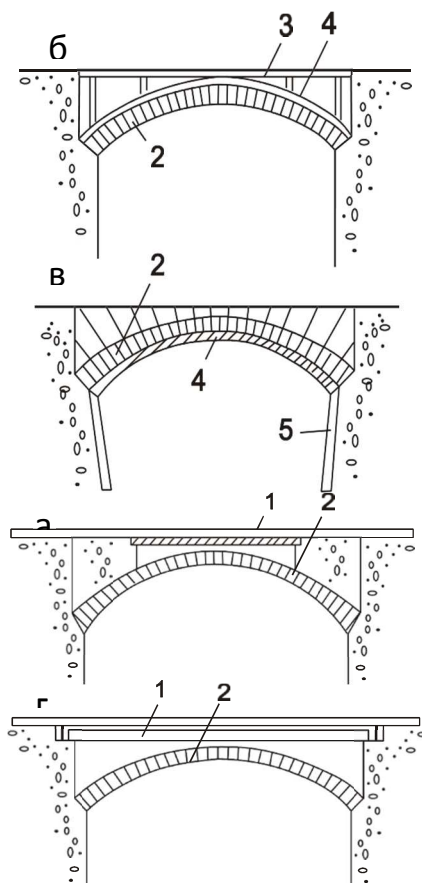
Схемы усиления сводов каменных и бетонных мостов: а – частичной или полной разгрузкой сводов; б – расположением дополнительного свода сверху существующего; в – то же, снизу существующего; г – путем устройства плитного пролетного строения; 1 – железобетонная плита; 2 – существующий свод; 3 – облегченное надсводное строение; 4 – свод усиления; 5 – уширение опоры
